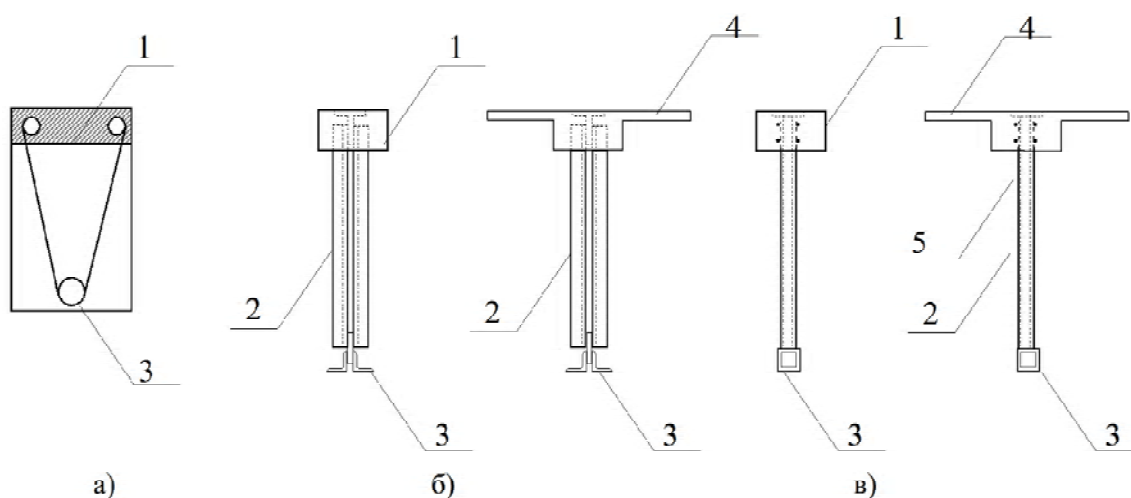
Поперечні перерізи конструкцій з винесеною робочою арматурою: а) залізобетонної балки з винесеною арматурою; б) сталезалізобетонної ферми з парних кутиків; в) сталезалізобетонної ферми з квадратних труб;
